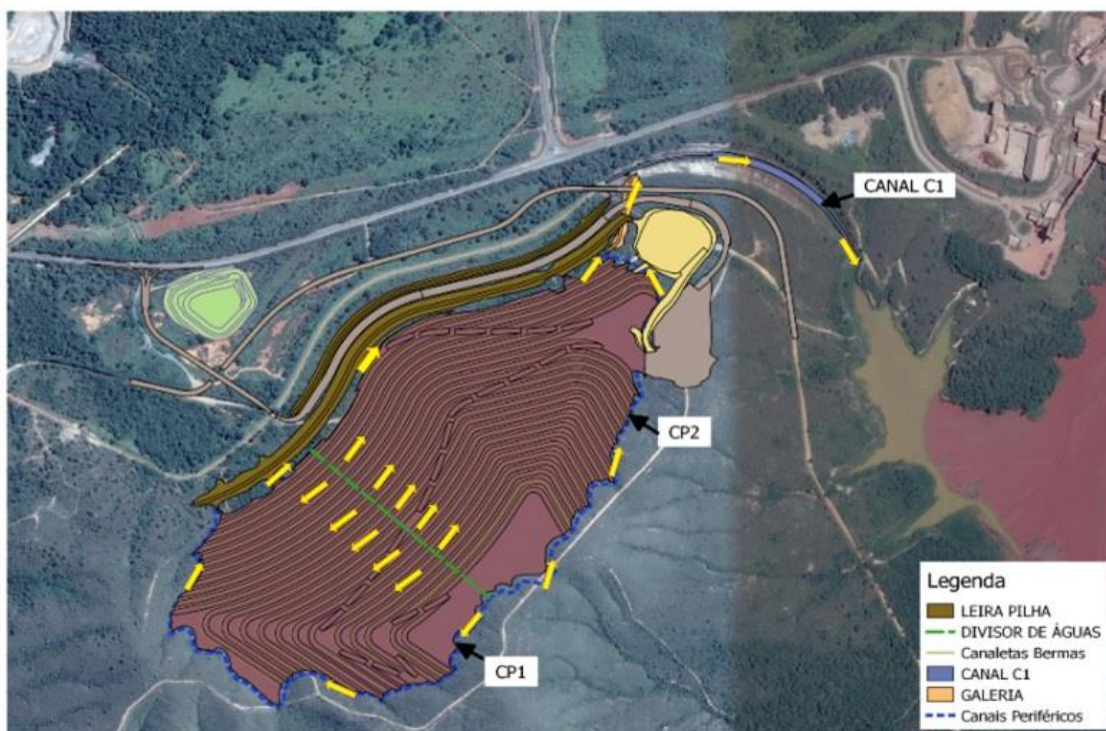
Layout* final em planta da pilha de rejeitos filtrados da Unidade Vazante (Nexa Resources, 2017)
